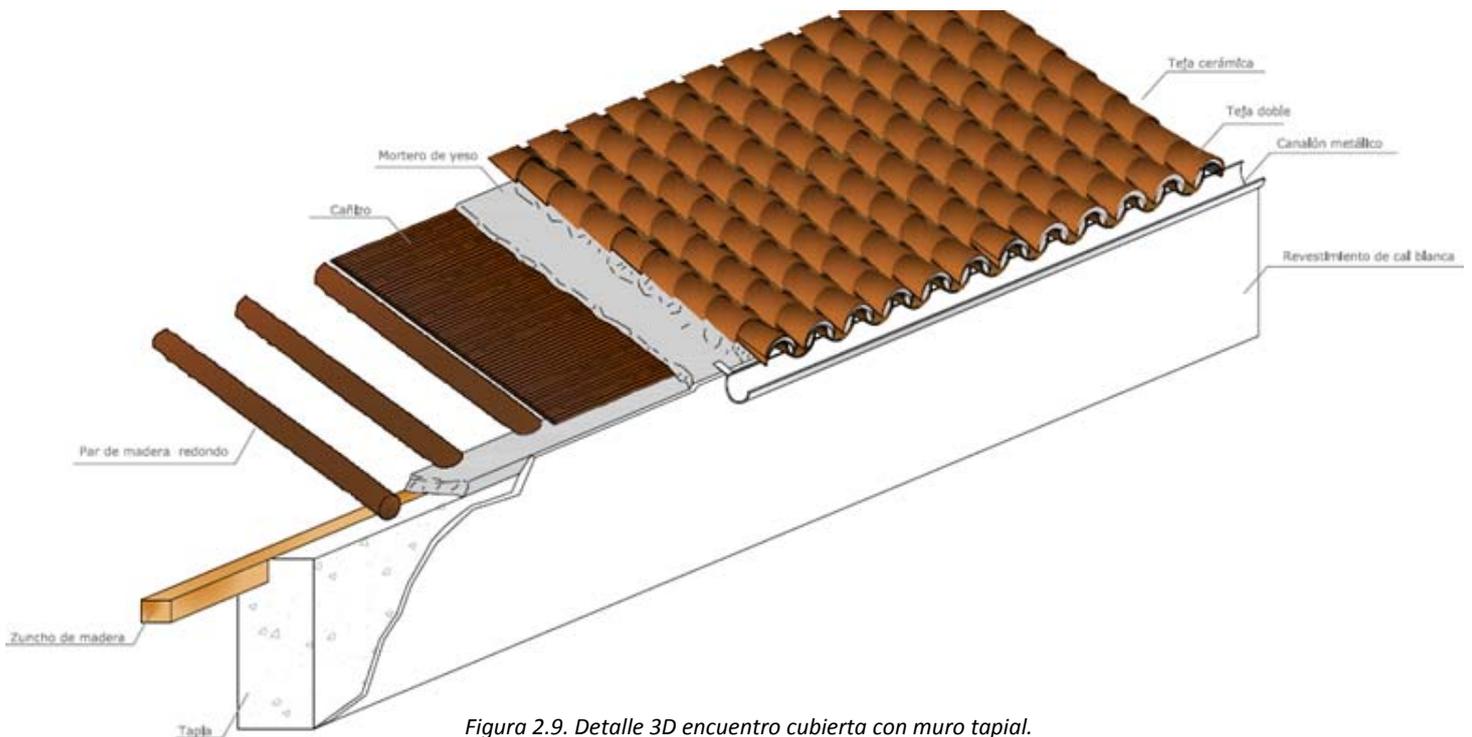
Detalle 3D encuentro cubierta con muro tapia.
